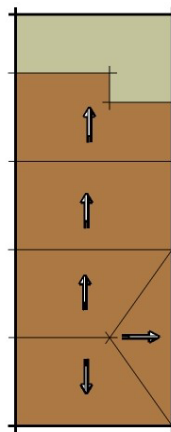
Planta rectangular, par e hilera con tres faldones y colgadizo
